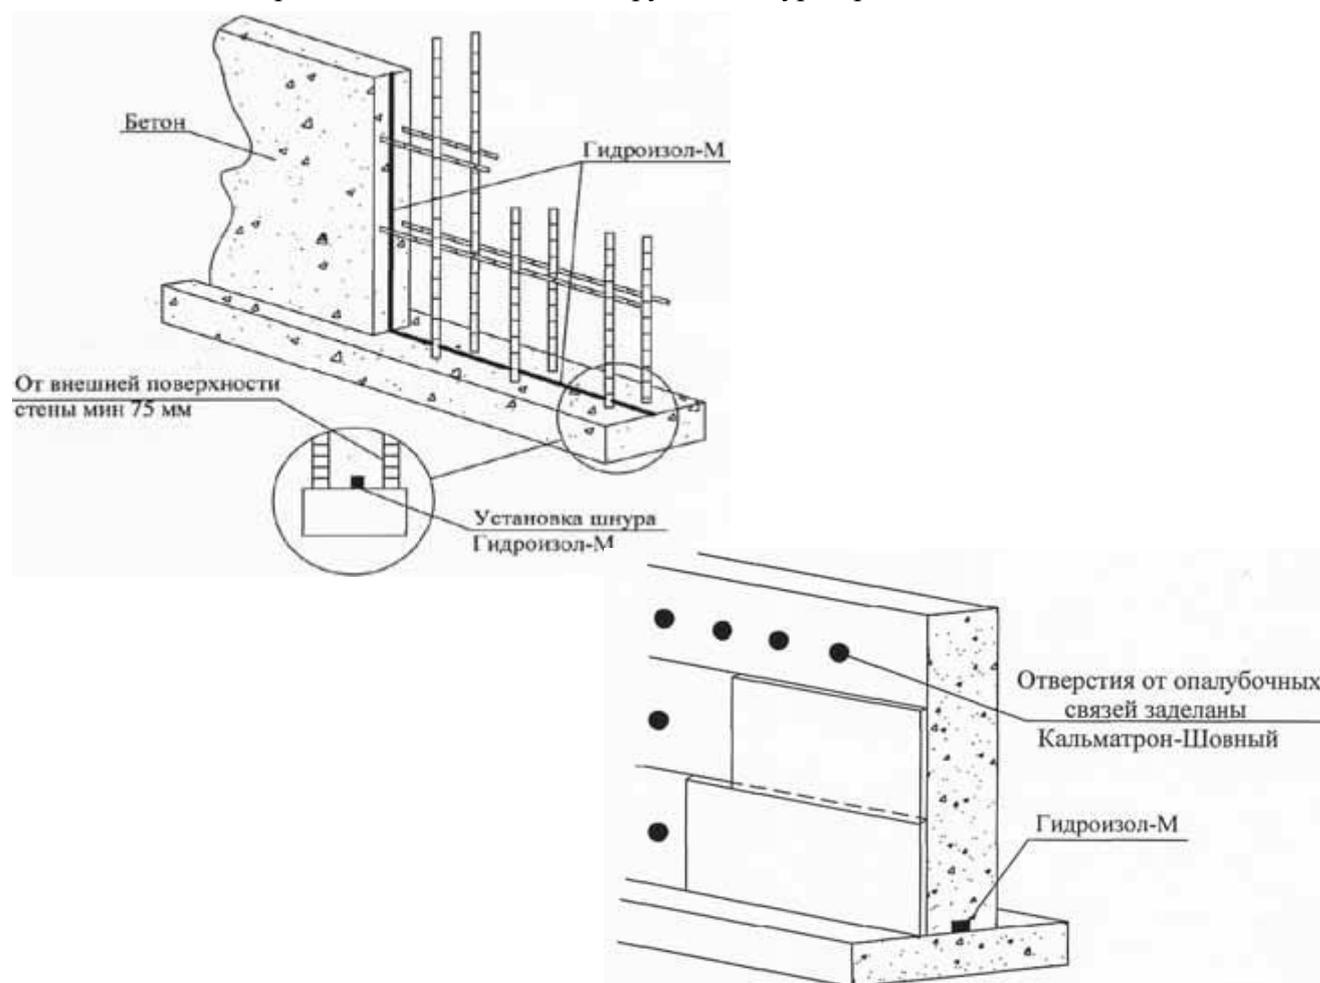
Схема установки шнура ГИДРОИЗОЛ-М
